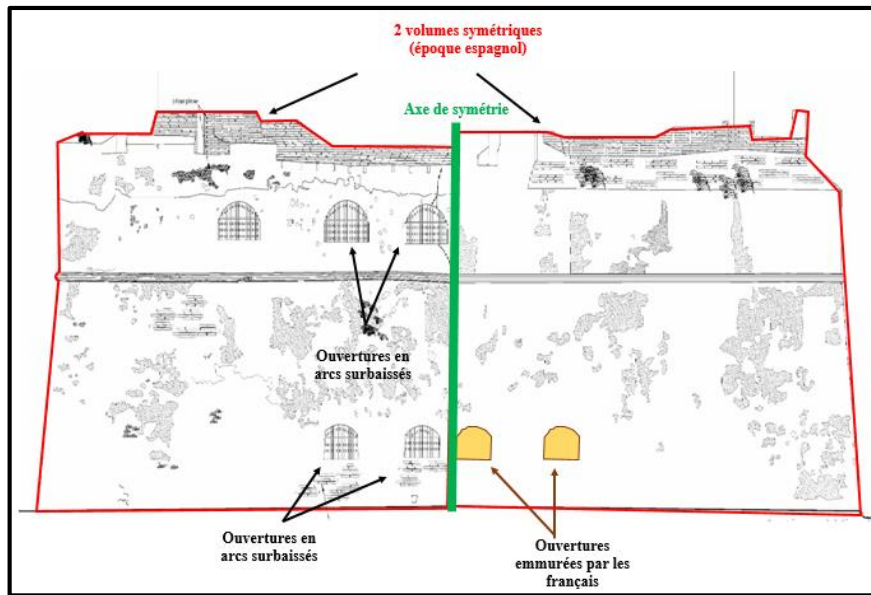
Façade Nord de Bordj Moussa (Source : BET MAHINDAD, traitée par l'auteur 2025).
